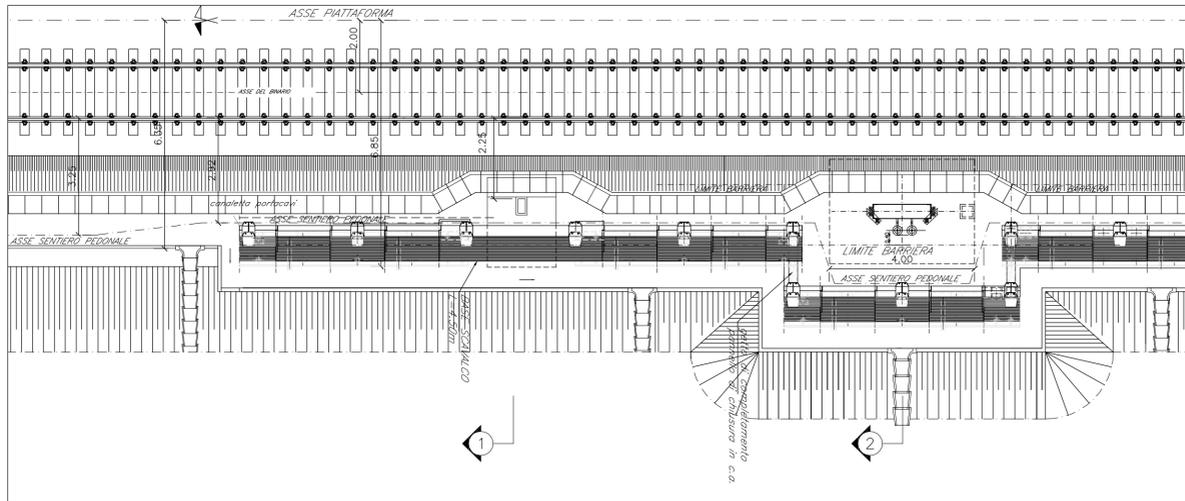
Stralcio planimetrico delle barriere fonoassorbenti
